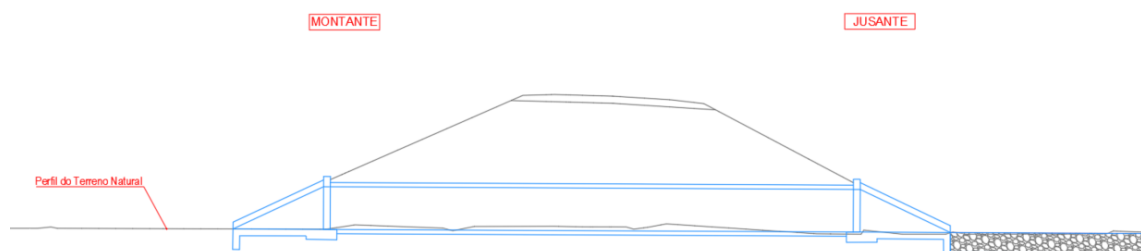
Corte longitudinal tipo da Passagem Hidráulica proposta
